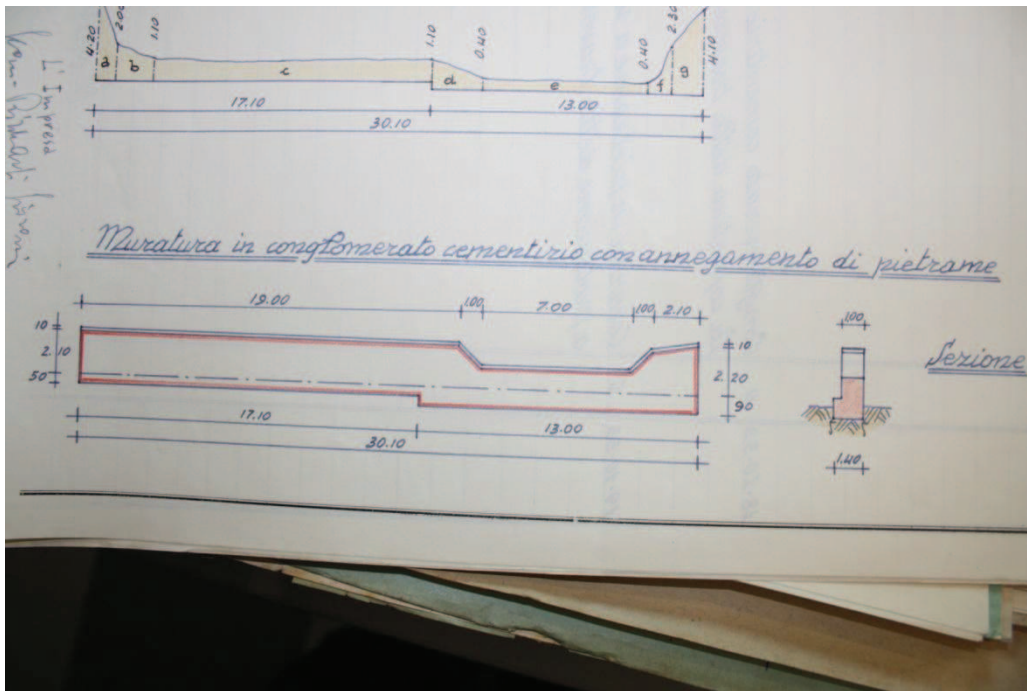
Dettaglio delle opere in muratura. Archivio CFS Brescia, 2011.
